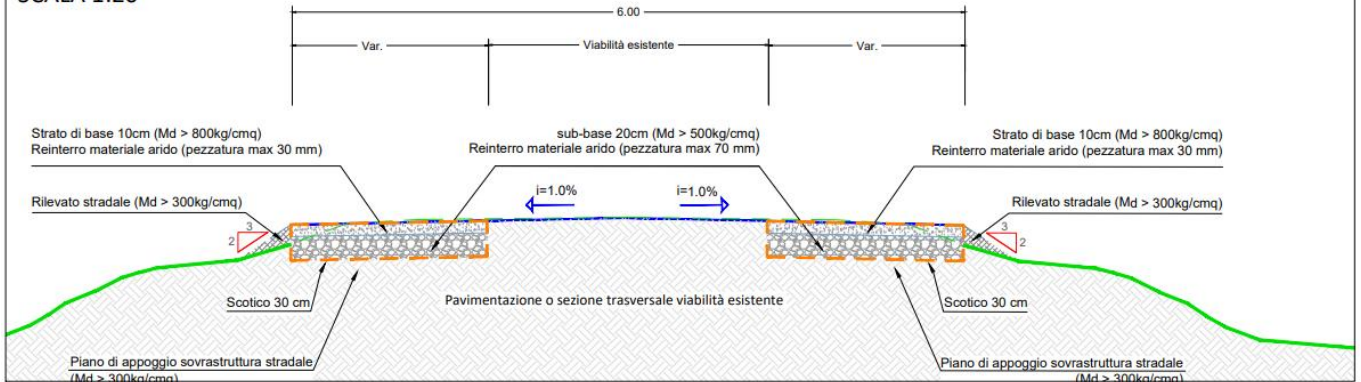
Sezione tipica viabilità esistente soggetta ad adeguamento
